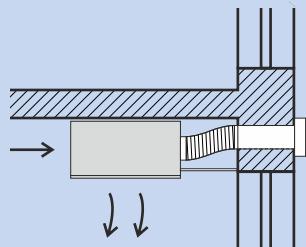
## DETAIL INSTALACE A FASÁDNÍCH PROSTUPŮ
